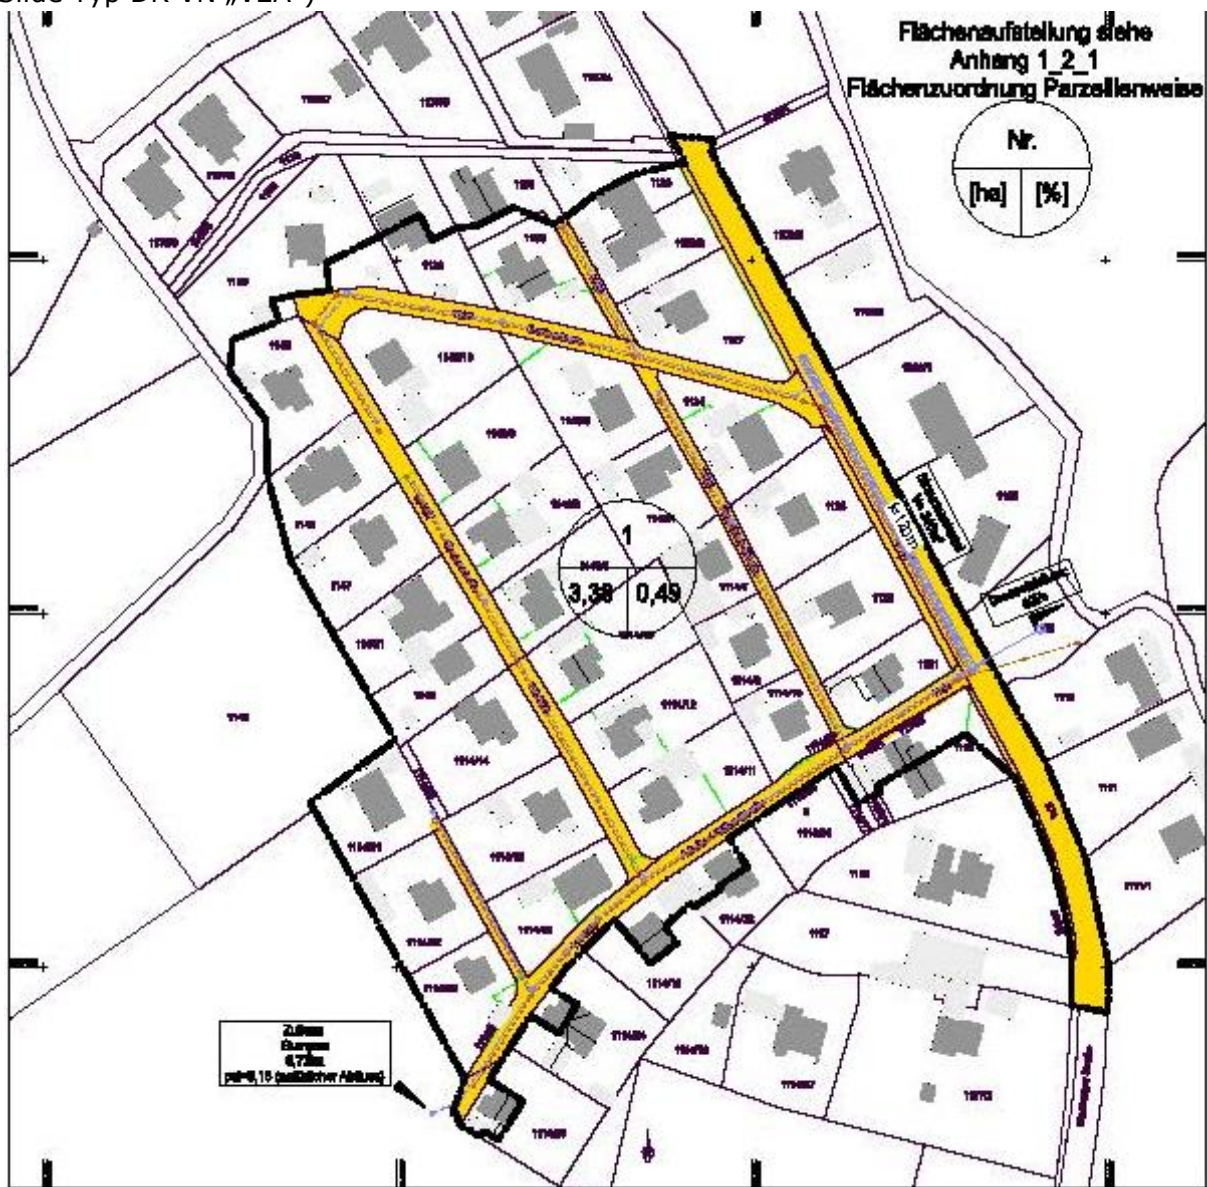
Lageplan mit der Leitungsführung in den Straßen, Quelle: (Architekturbüro Würmseher 2024)
